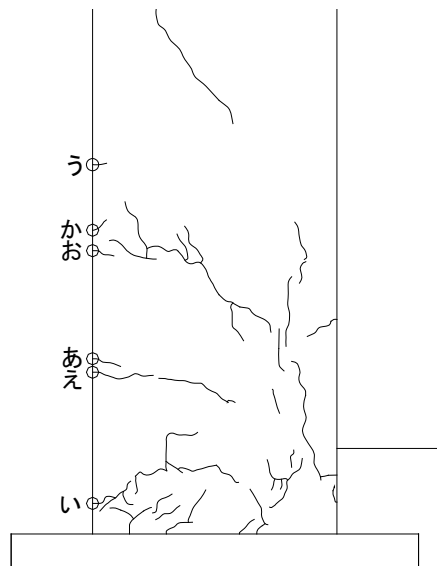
3. 304 柱ひび割れ幅測定位置 (試験体 A-7a 正載荷)
